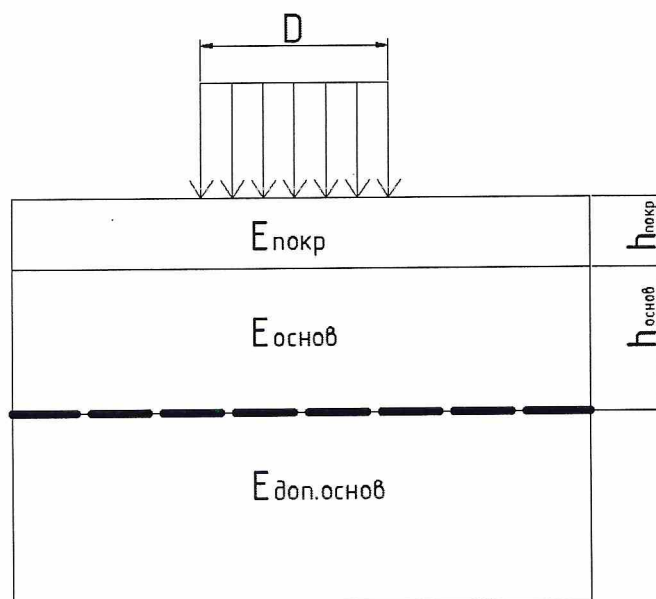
Расчетная схема дорожной одежды капитального и облегченного типов, армированной георешеткой марки СТАБАРМ.
